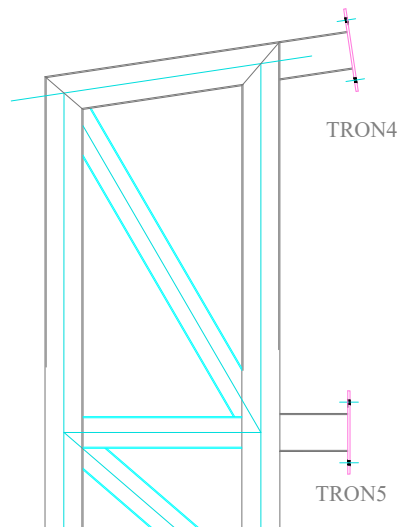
Vue générale du nœud d'assemblage ferme-poteau
